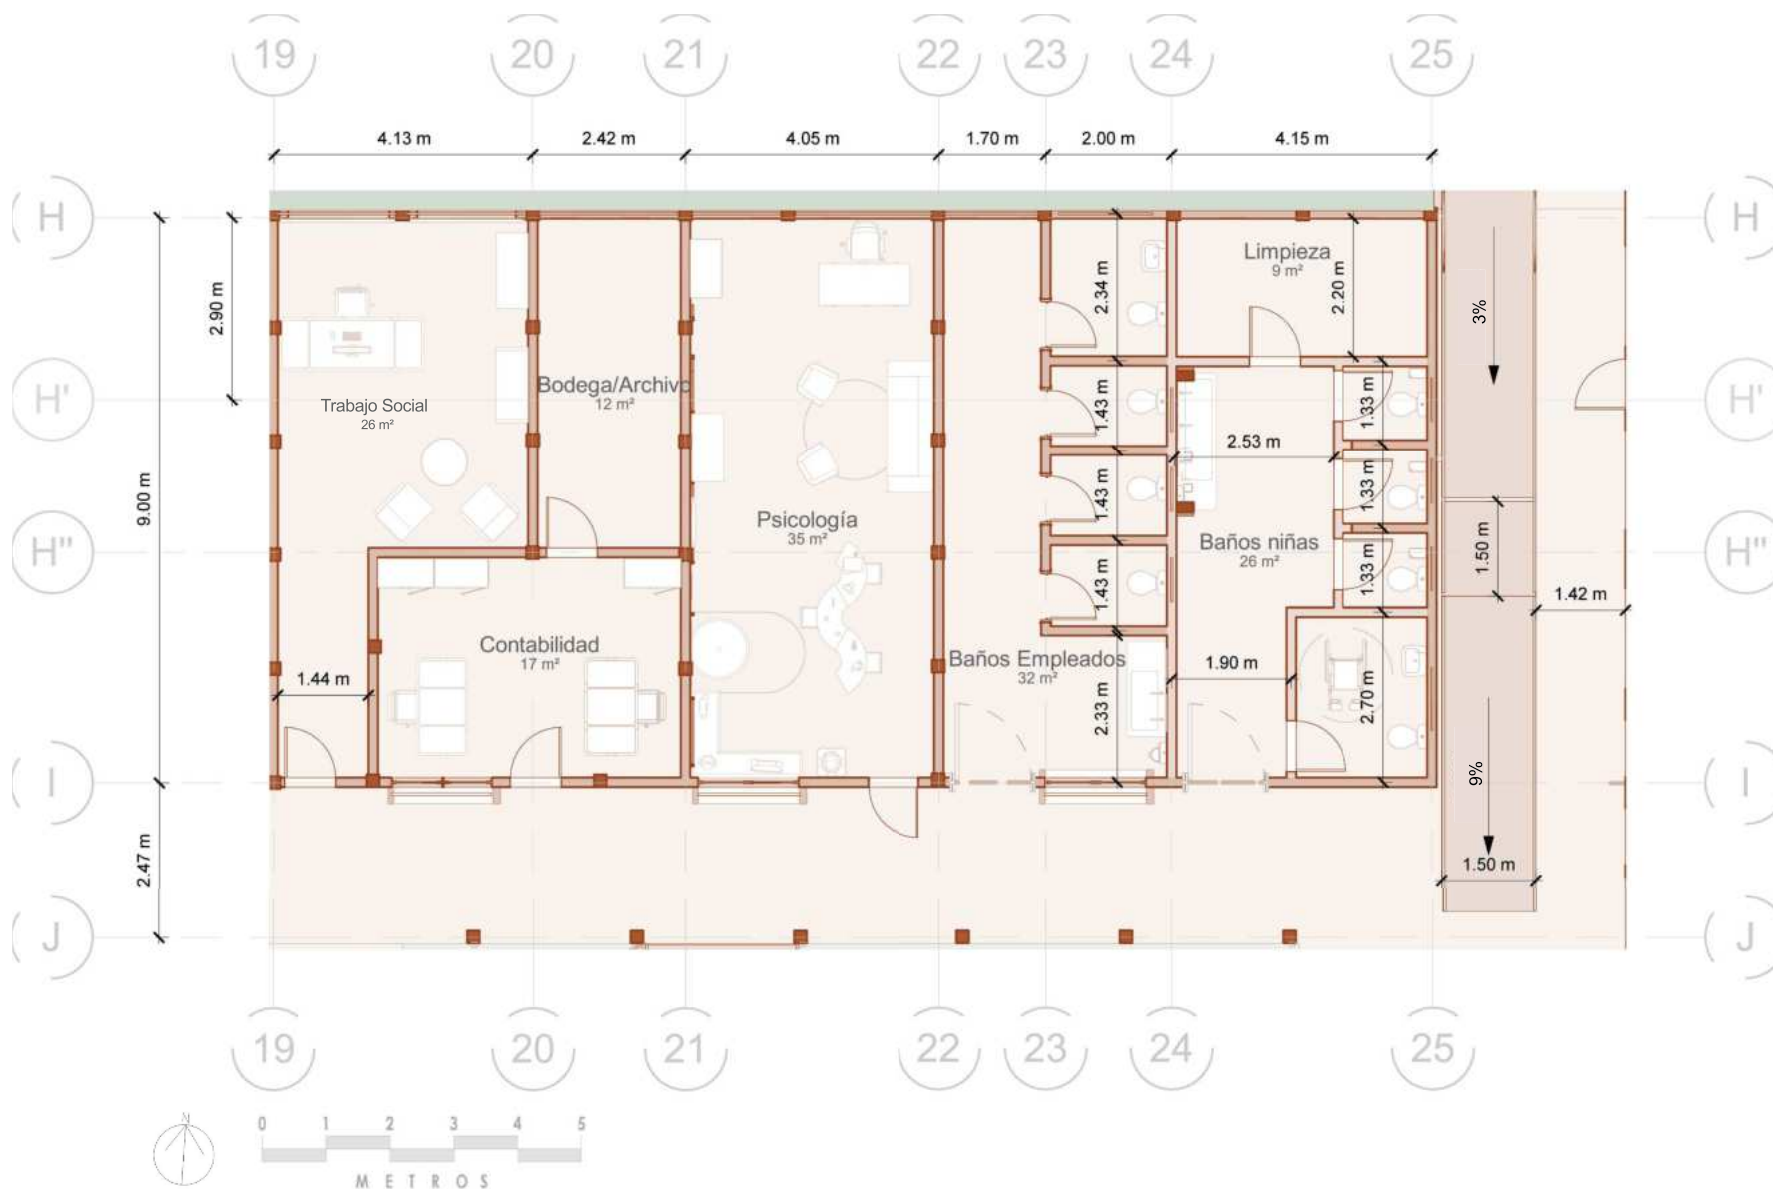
Planta arquitectónica de Trabajo social, contabilidad, psicología y baños | Fuente: Elaboración propia
